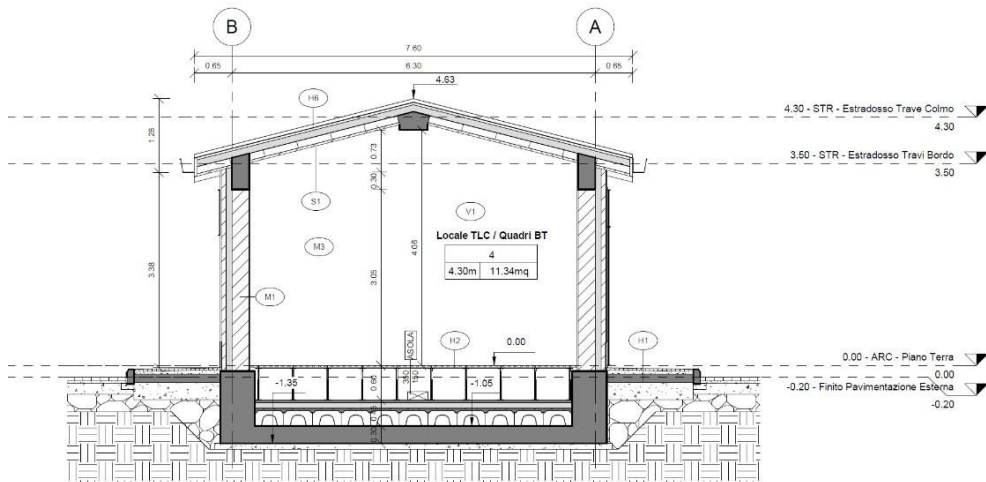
Sezione A – A – Layout Fabbricato FA01
